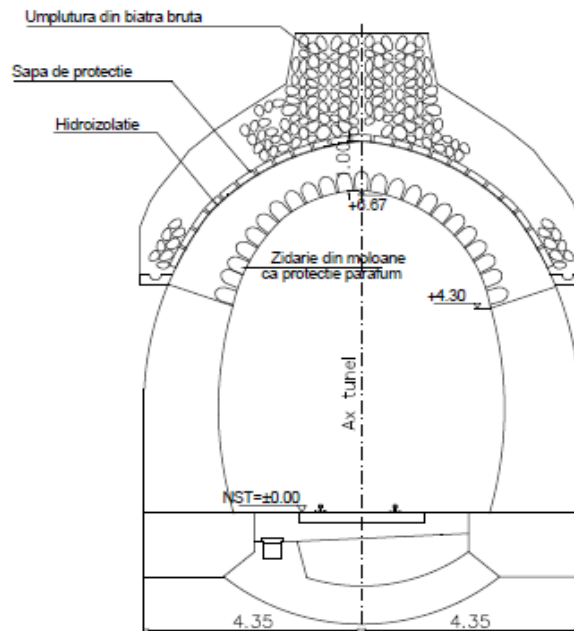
Secțiunea tip potcoavă
